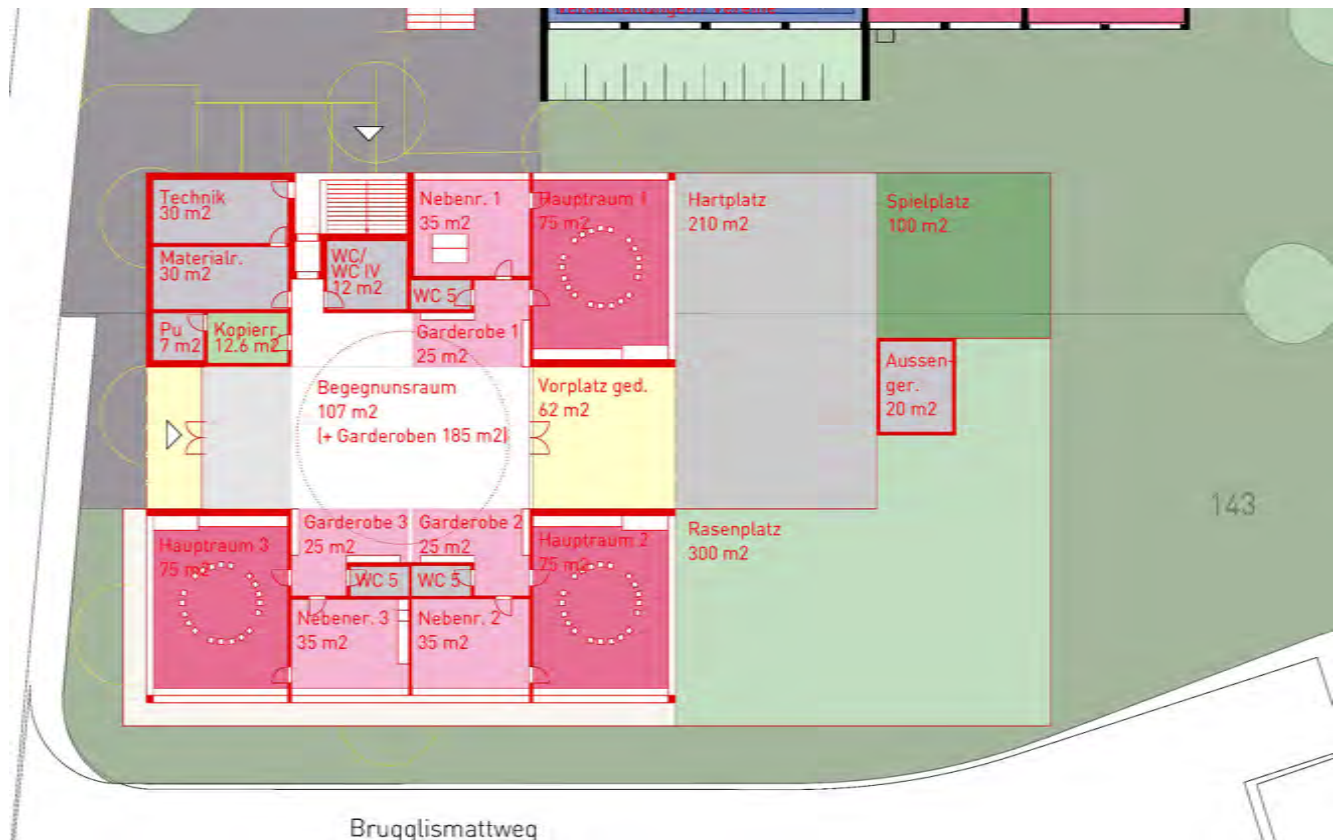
Grundriss, Kindergarten im Erdgeschoss
